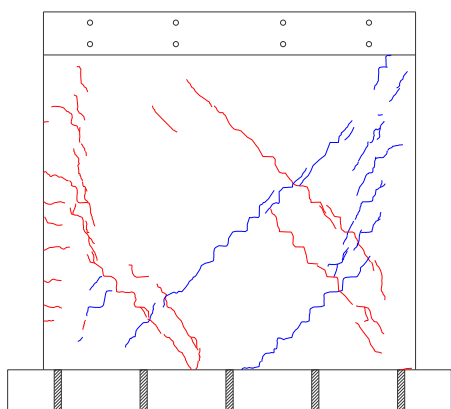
Reparación tipo I en muro de albañilería confinada con ladrillos sólido artesanal en la distorsión 1/1000.
